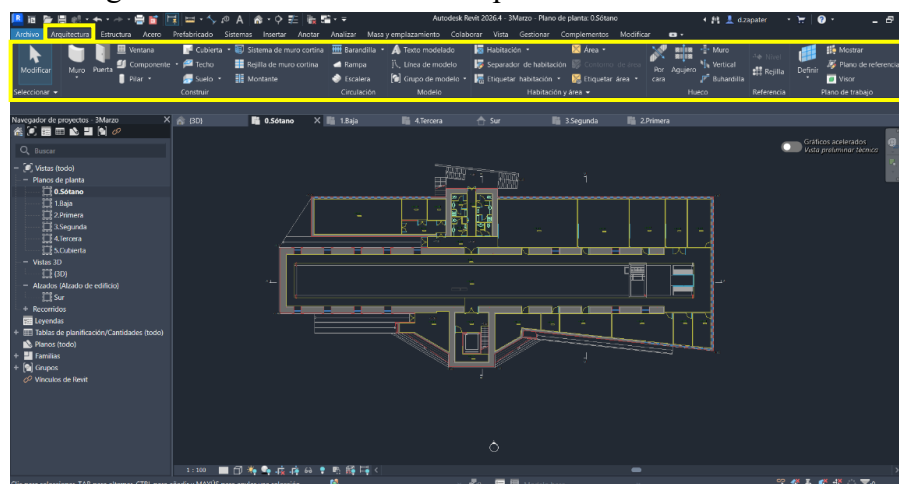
Introducción de los elementos constructivos sobre la plantilla. Fuente: Autodesk Revit.
